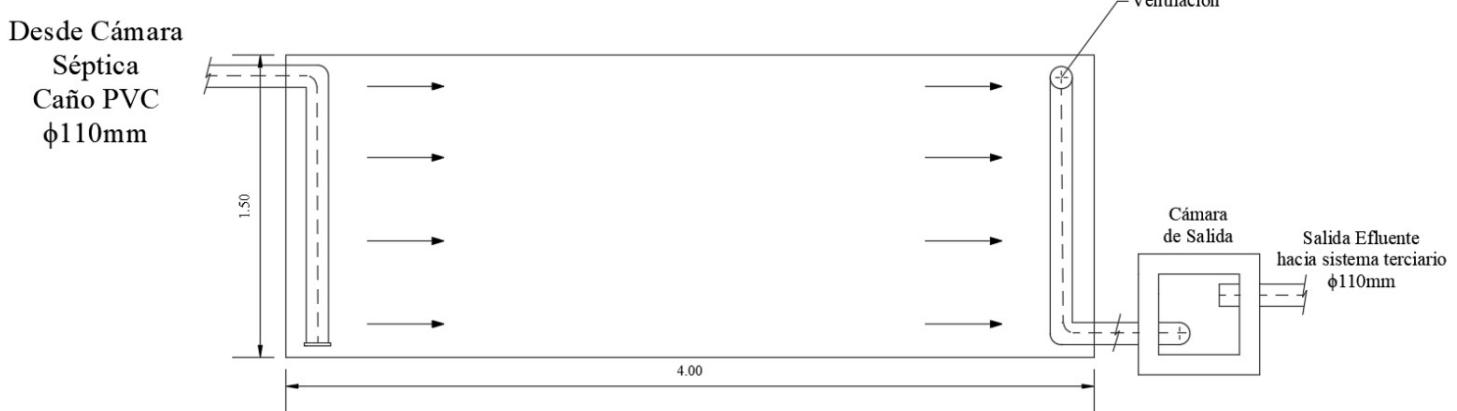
Vista en planta de humedal subsuperficial (1.5 x 4 m)
